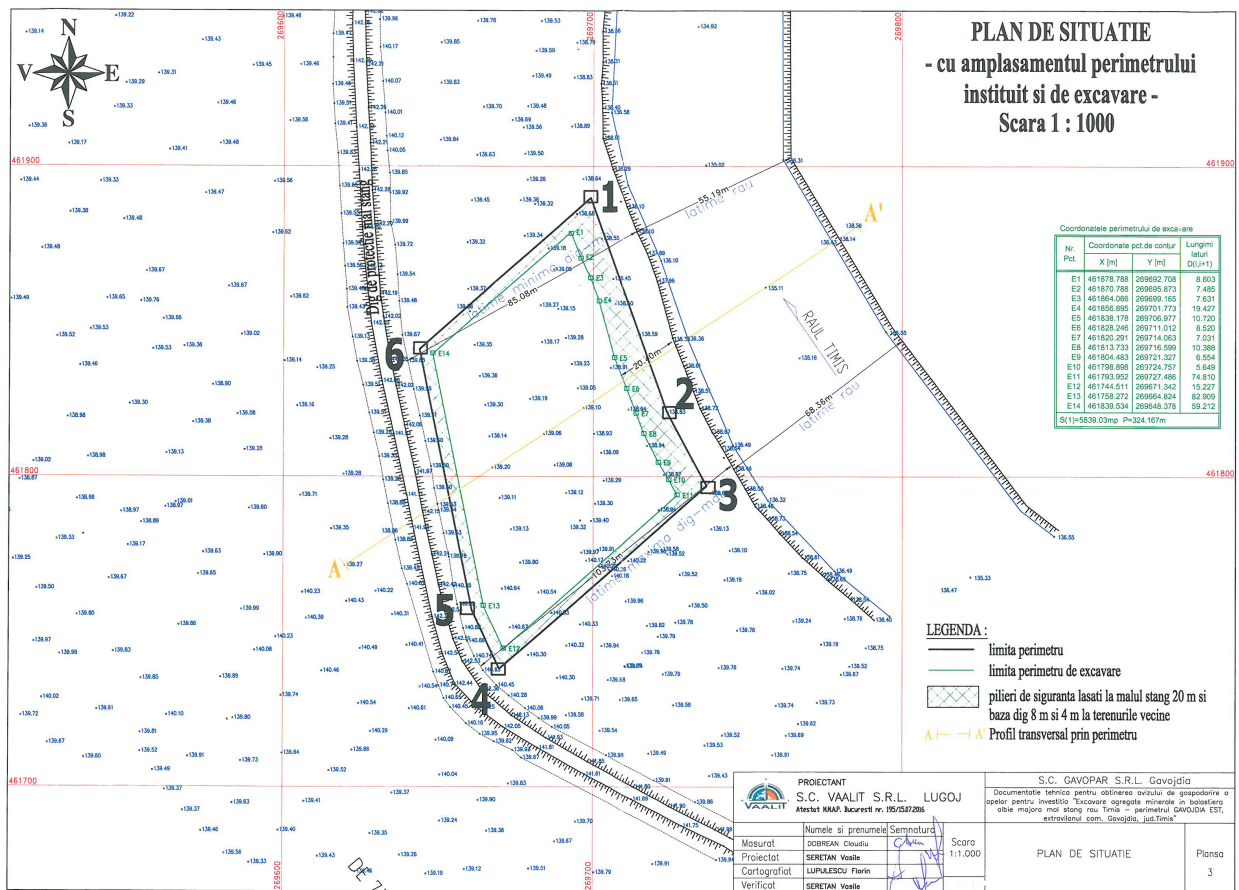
Plan de situație cu amplasamentul perimetrului.
